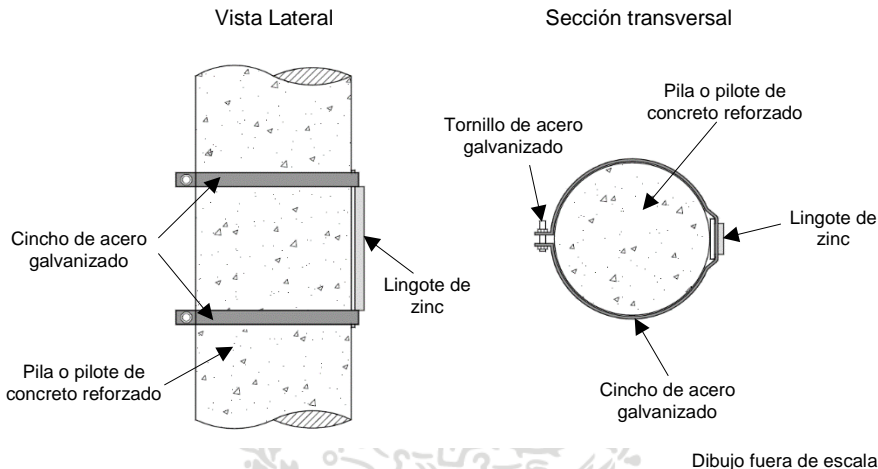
Ejemplo de un lingote de zinc instalado en una pila de concreto reforzado de sección circular
